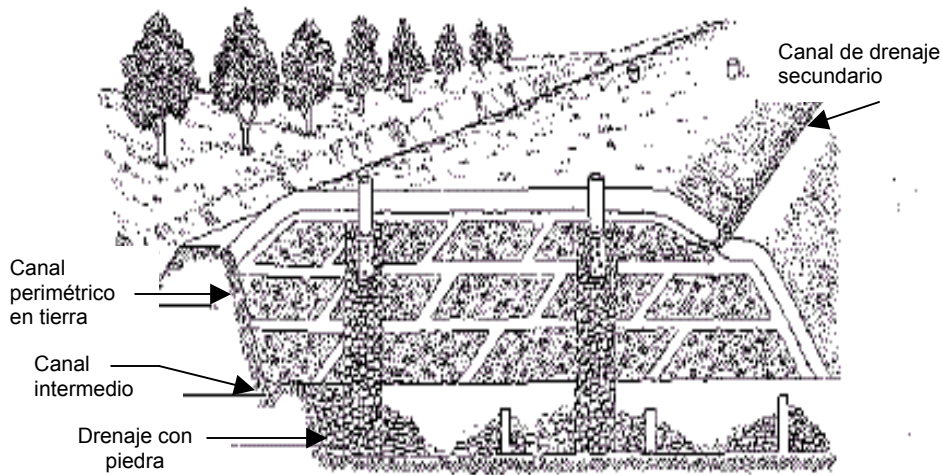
Detalle constructivo de chimeneas de evacuación de gases
